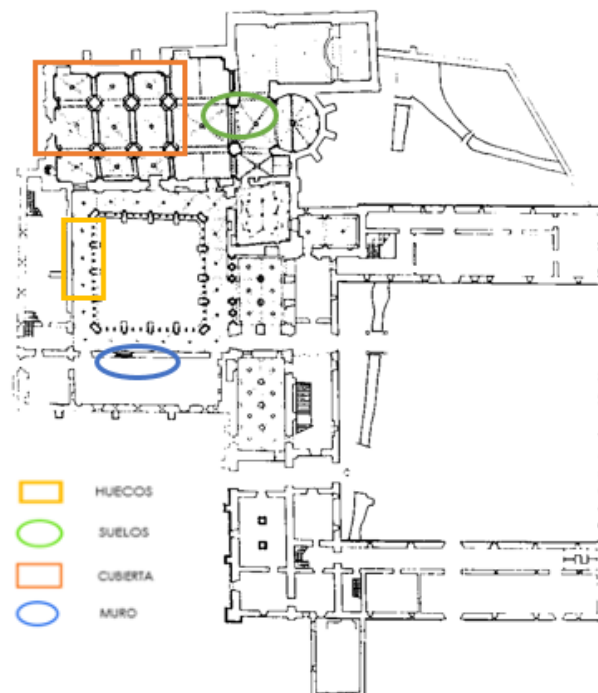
Plano de localización de los elementos a intervenir en el monasterio de Santa María la Real. Fuente: elaboración propia
